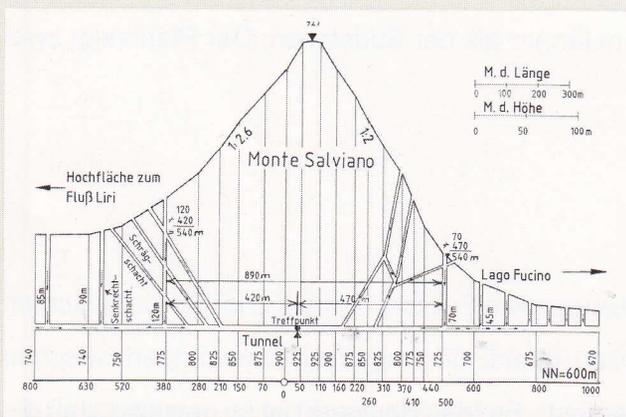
Planungsschema des Tunnels unter dem Monte Salviano, Zeichnung von Konrad Peters
